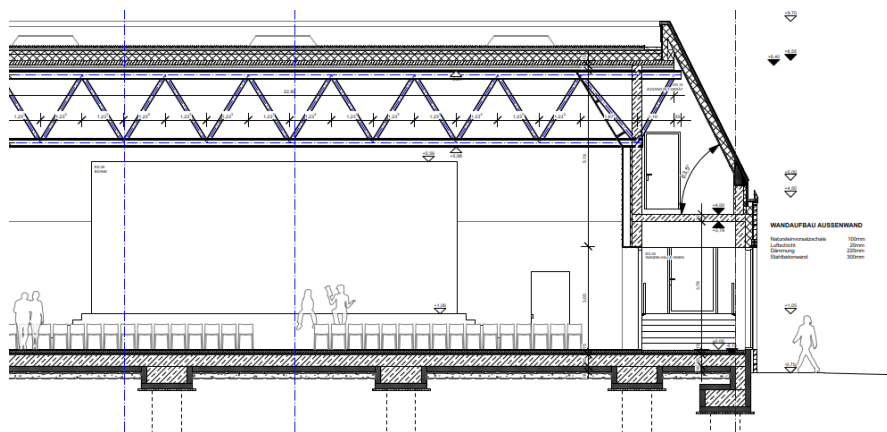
Geplanter Trennwandanschluss an das Holzdach gemäß [1].
